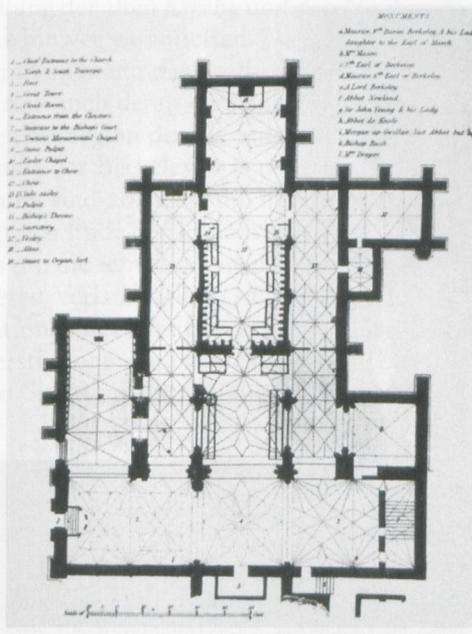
Bristol, ehem. Stiftskirche, Grundriss Chor und Querhaus
